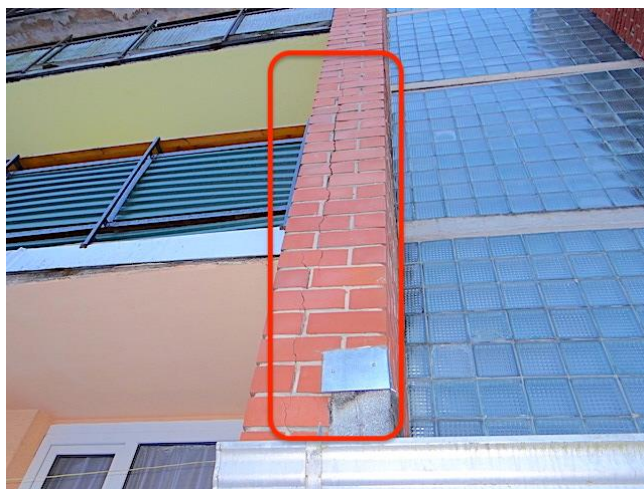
att. Plaisa lodžijas pilastrā ēkas Rietumu pusē
